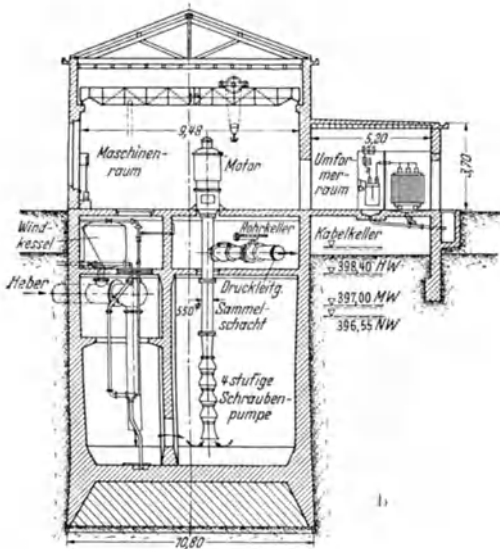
und b. Hauptpumpstation Hardhof mit Sammel-schacht der Stadt Zürich.
